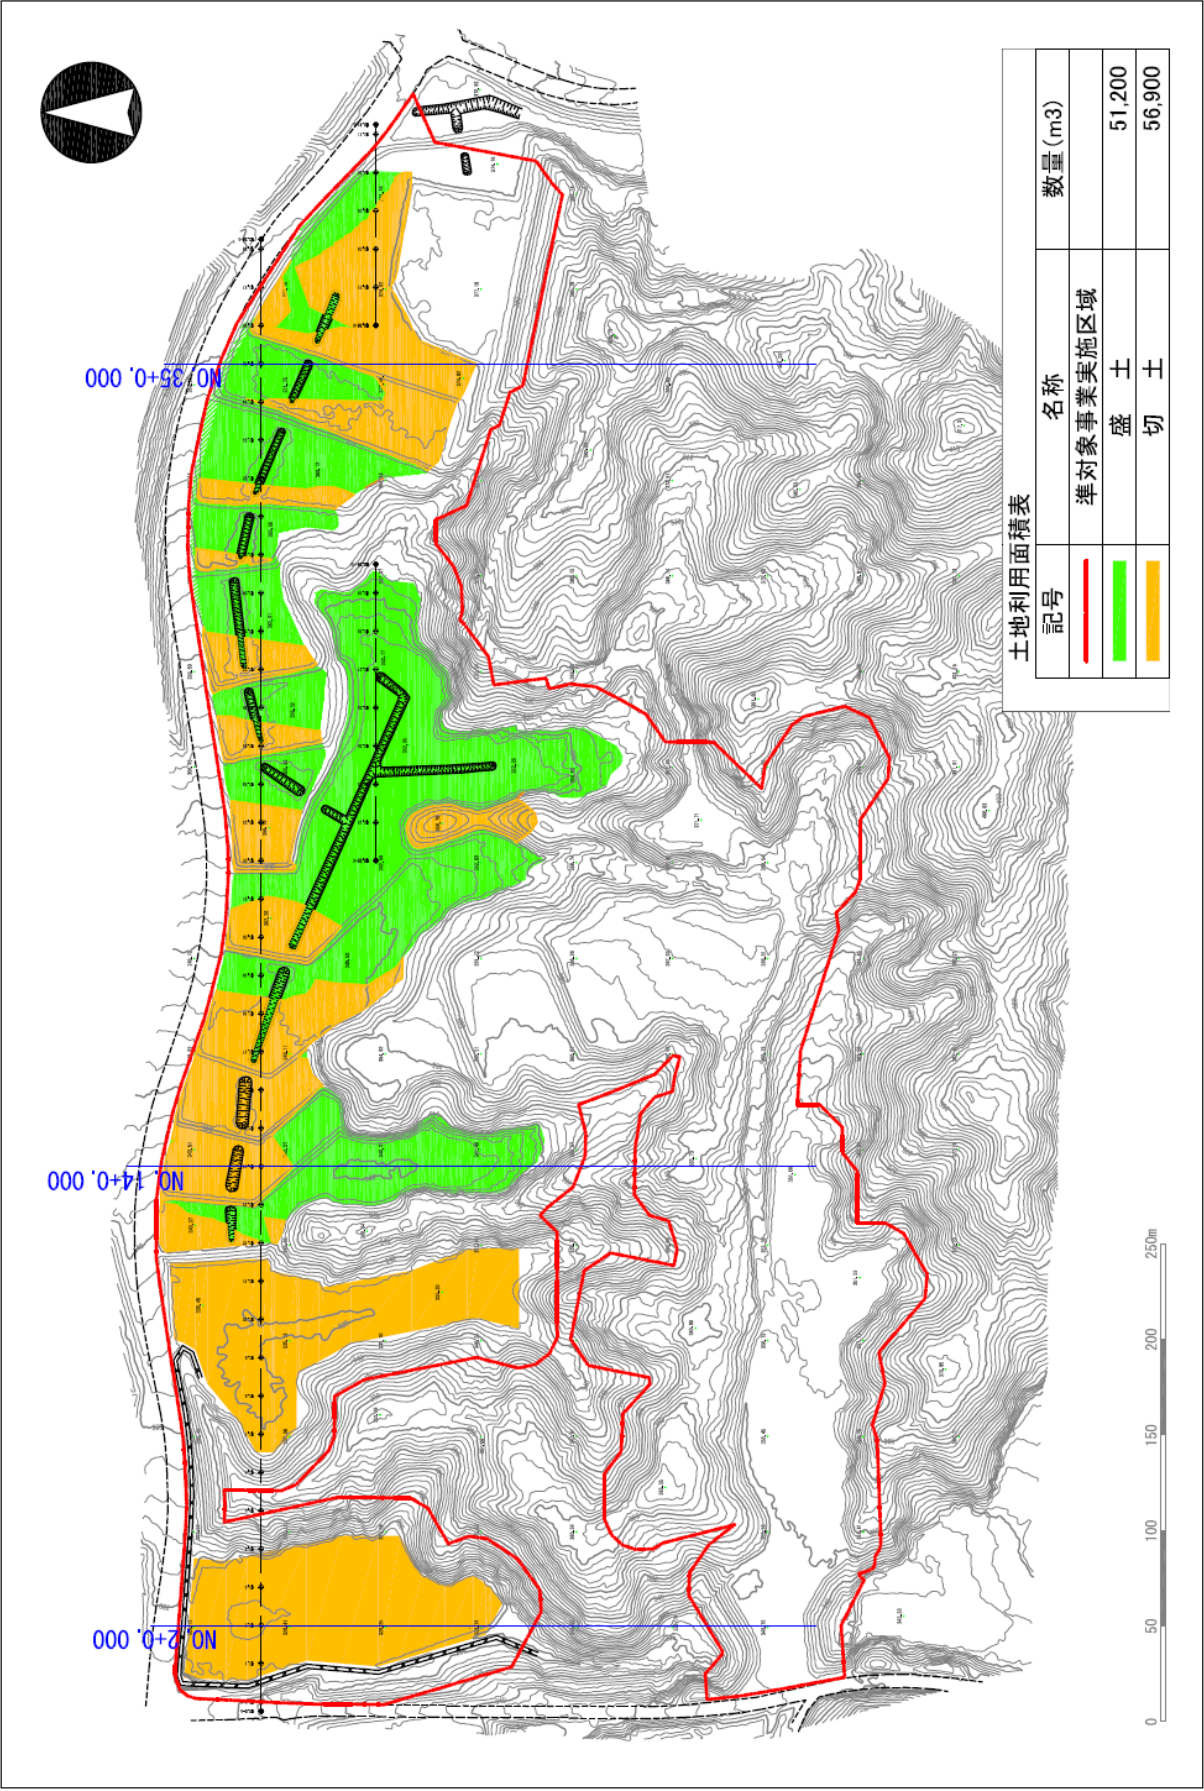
(2) 切土・盛土平面図 (変更前計画)
